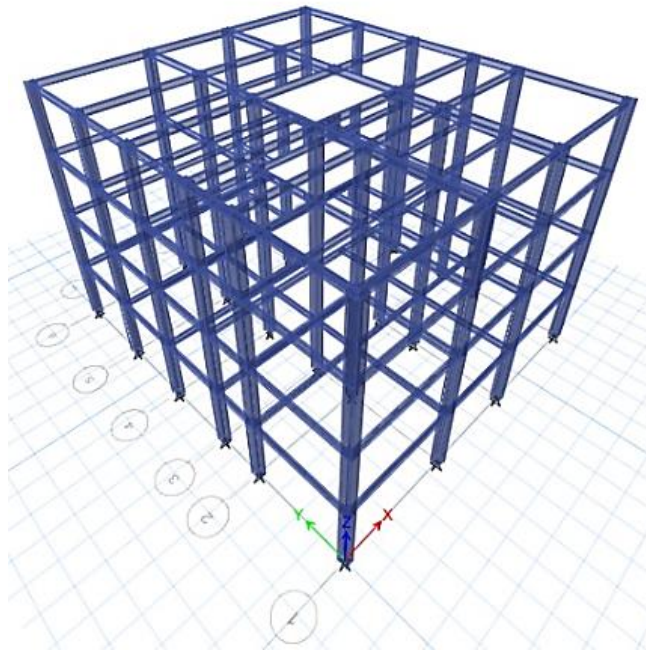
Vista 3D de los elementos Estructurales de la edificación de 4 piso (Etabs)
